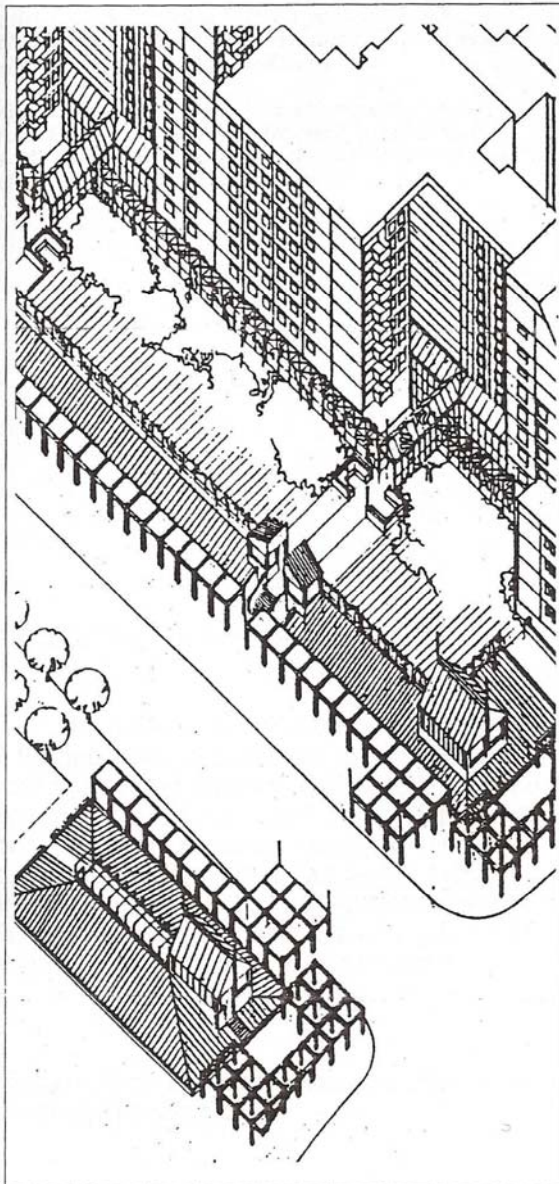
Märkisches Viertel, proposta dell' arch. Schmidt, Thomsen, di Wohnumfeldbesserung del complesso progettato dall'architetto Leo (1).
